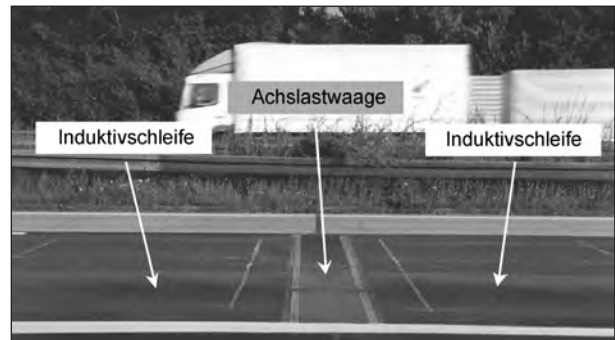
Beispielhafte Darstellung einer in den Hauptfahrstreifen einer BAB eingebauten Biegeplatte zur Achslasterfassung
